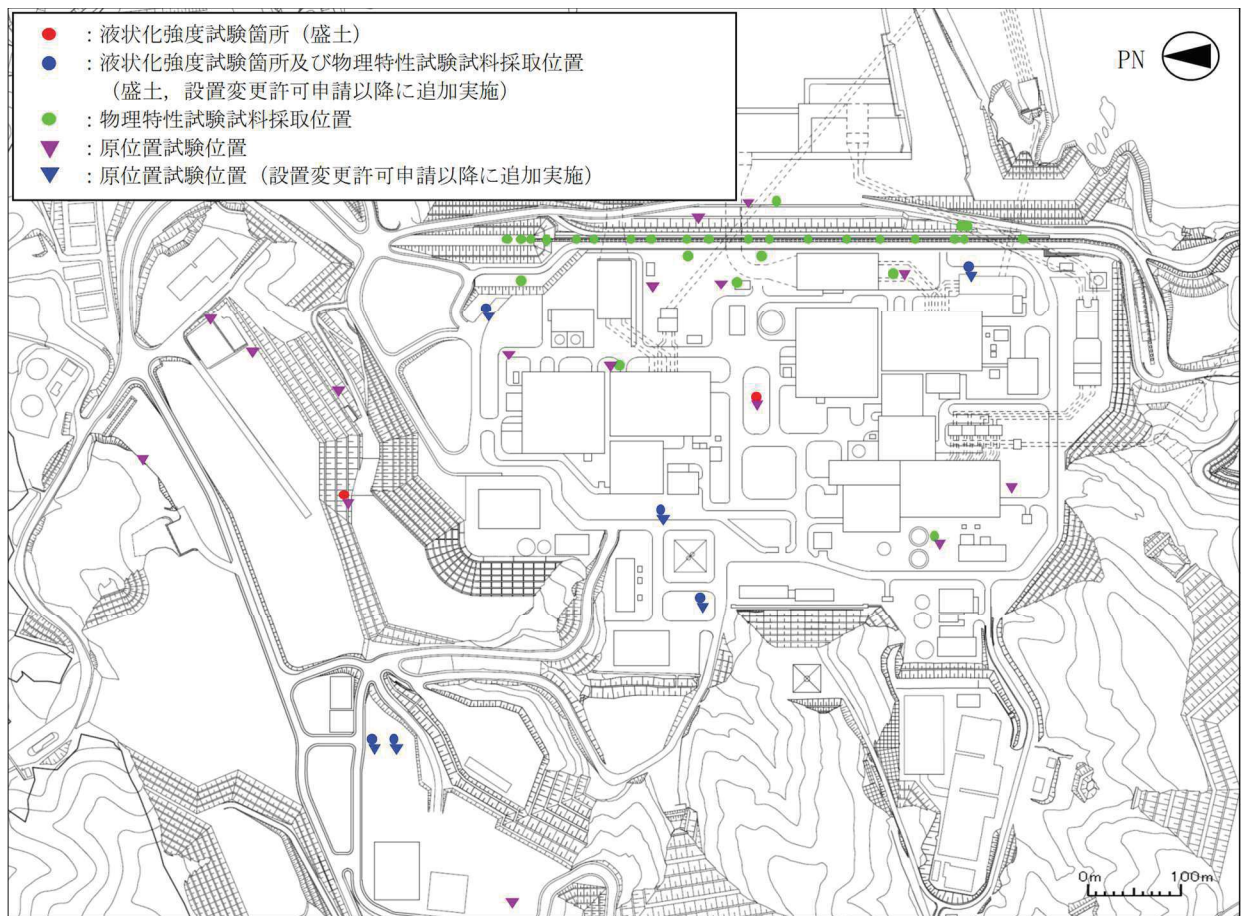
盛土の液状化強度試験位置並びに原位置試験及び物理特性試験採取位置の平面図
